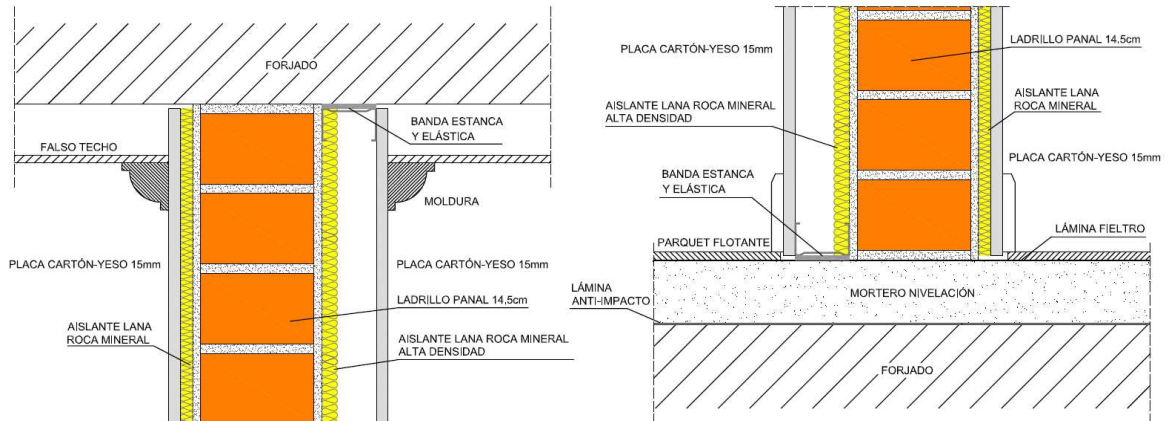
y 16. Detalle encuentro con pavimento y con falso techo.
